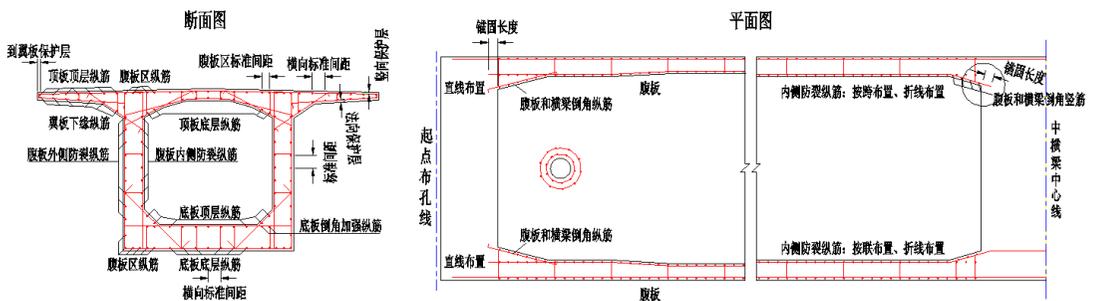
箱梁钢筋-纵筋断面及平面示意
